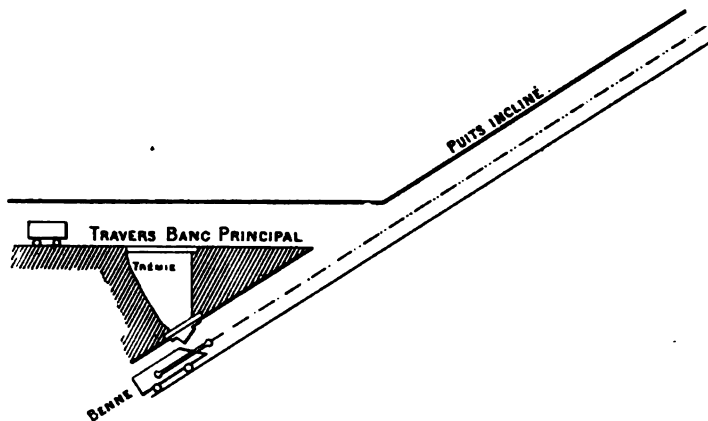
Disposition en coupe verticale du chargement dans un puits incliné.
